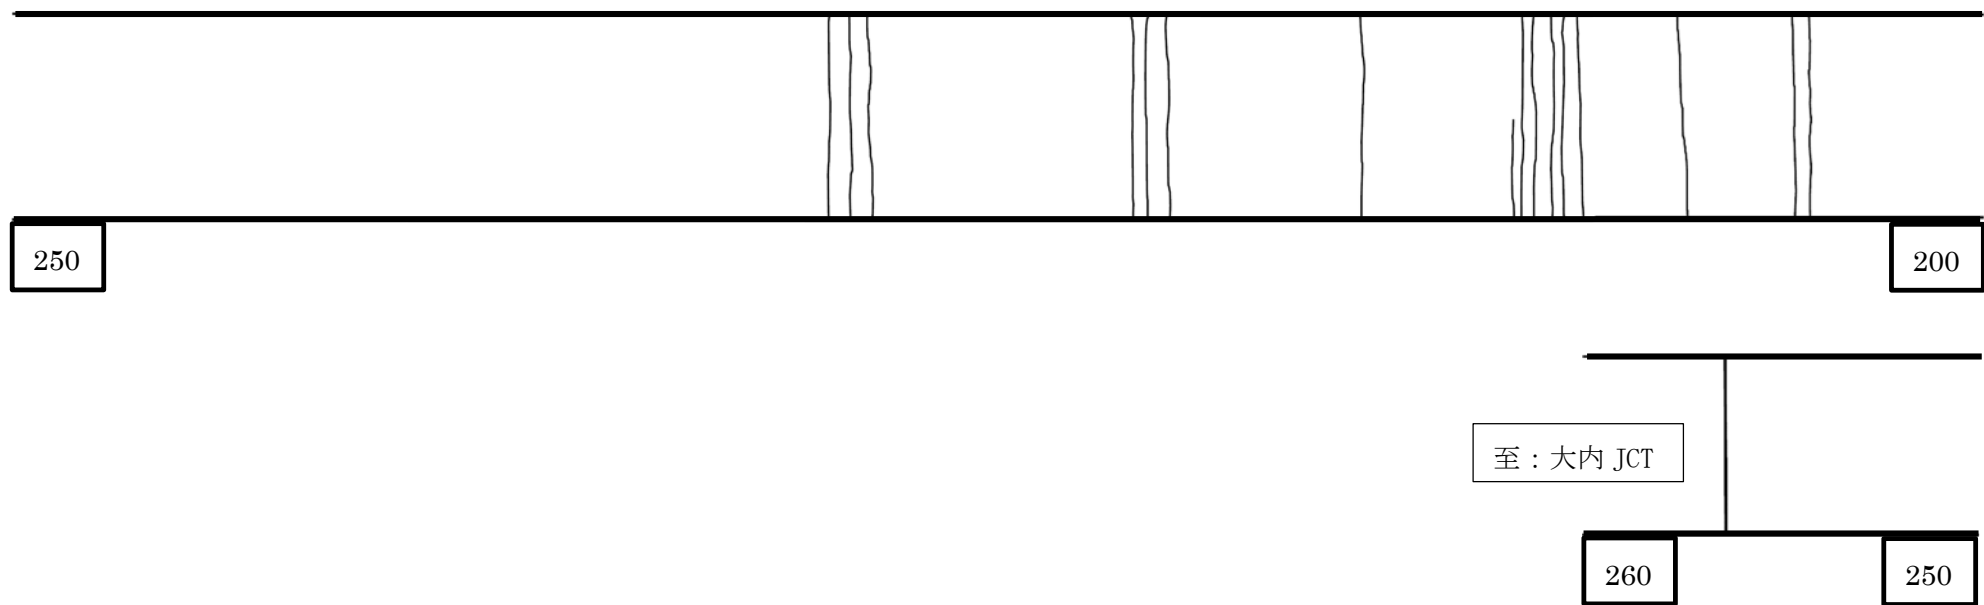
ひび割れ平面図 (ACC 無し区間 260m)
